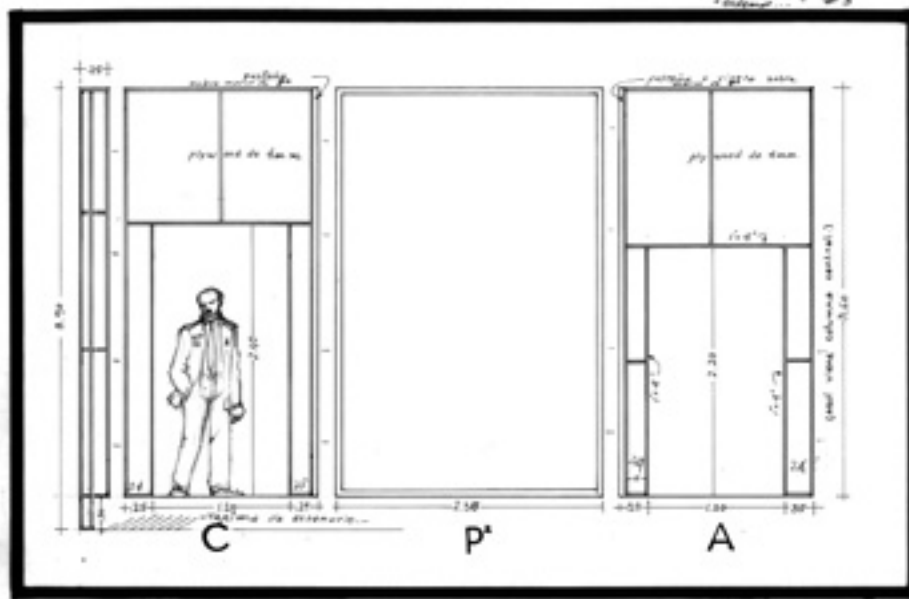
Dibujo de construcción con los detalles para las columnas y las paredes. Cada sección de ambas paredes es exactamente igual.
